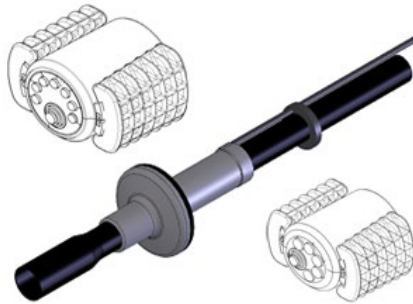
Mauerdurchführung MD60 mit Rohranschluss und Abdichtelemente EZA-t 50 außen und EZA-t 40 innen
